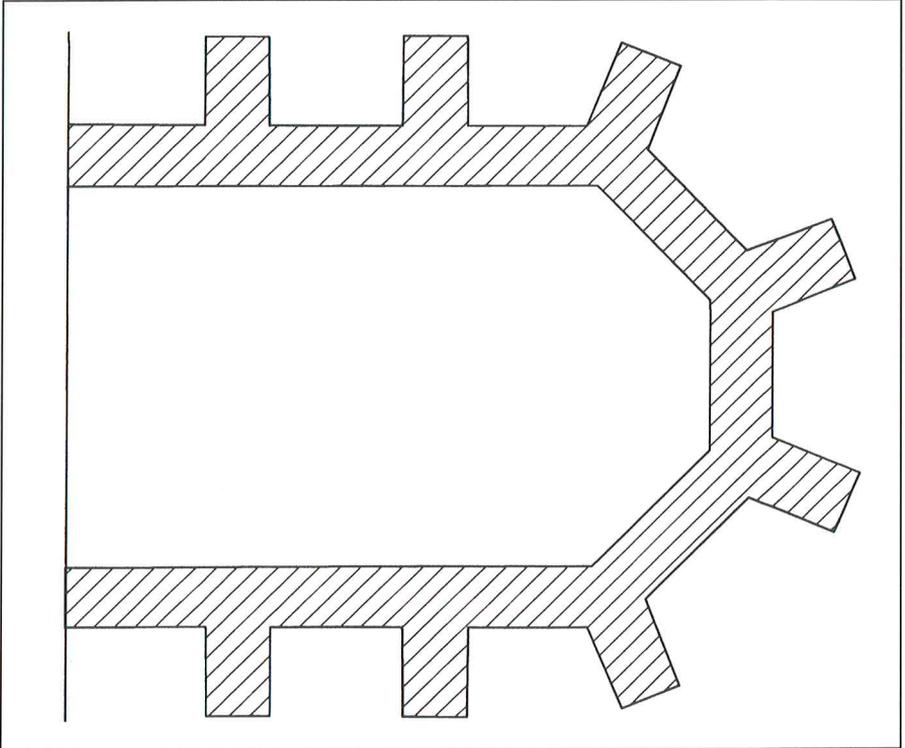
Osterhofen-Altenmarkt. Rekonstruierter Grundriss der Puchberger-Kapelle. – M. 1:100.
